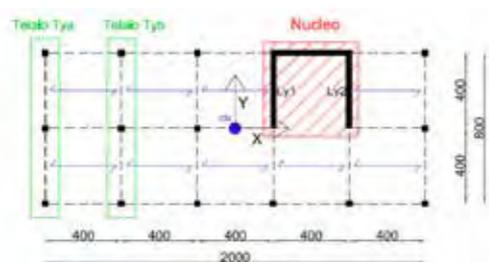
Schema in pianta dell'edificio tipo analizzato (misure in cm)
